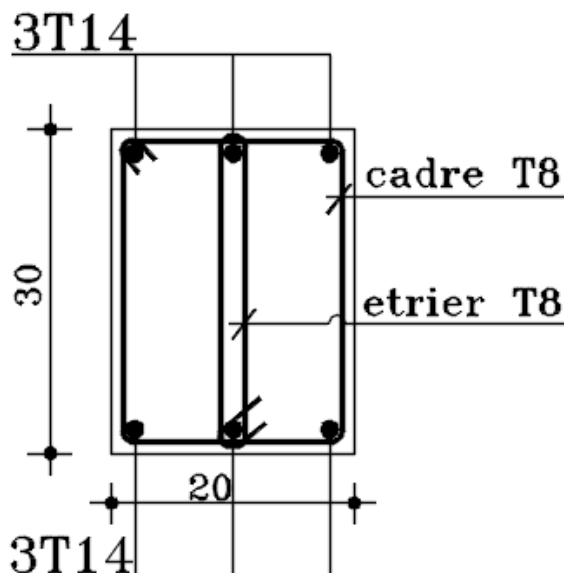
FERRAILLAGE DU POUTRE PALIERE
